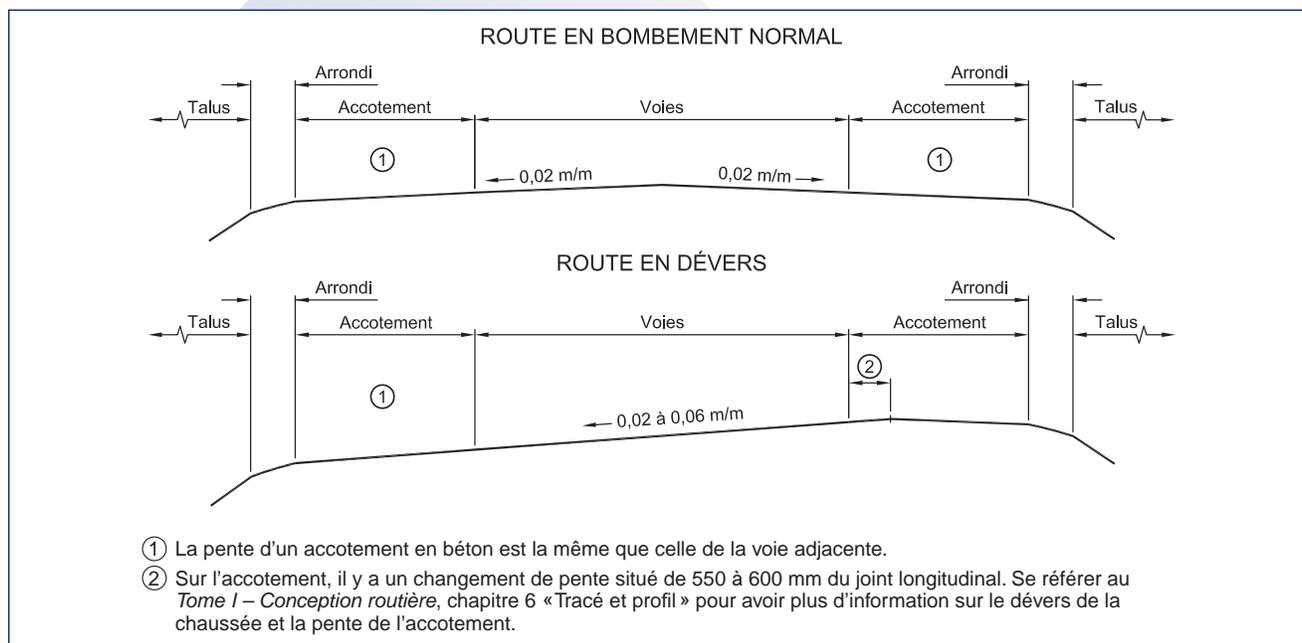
Dévers de la chaussée en béton et pente d'accotement
